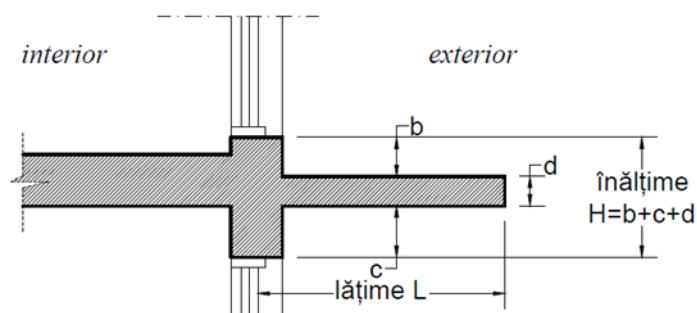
Concept însumare elemente verticale cu elementele orizontale având aceeași rezistență la foc
